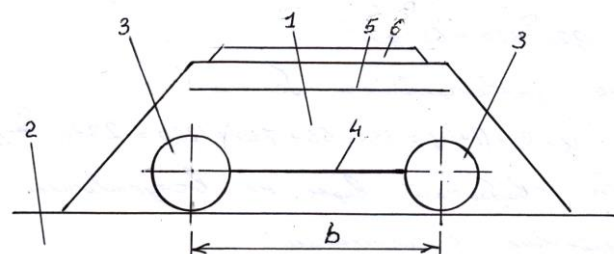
Поперечный разрез насыпи с расположением железнодорожных цистерн на мерзлом основании: 1 – насыпь; 2 – мерзлое основание; 3 – отработанные цистерны; 4 – канат; 5 – геосетка (геополотно); 6 – балласт
